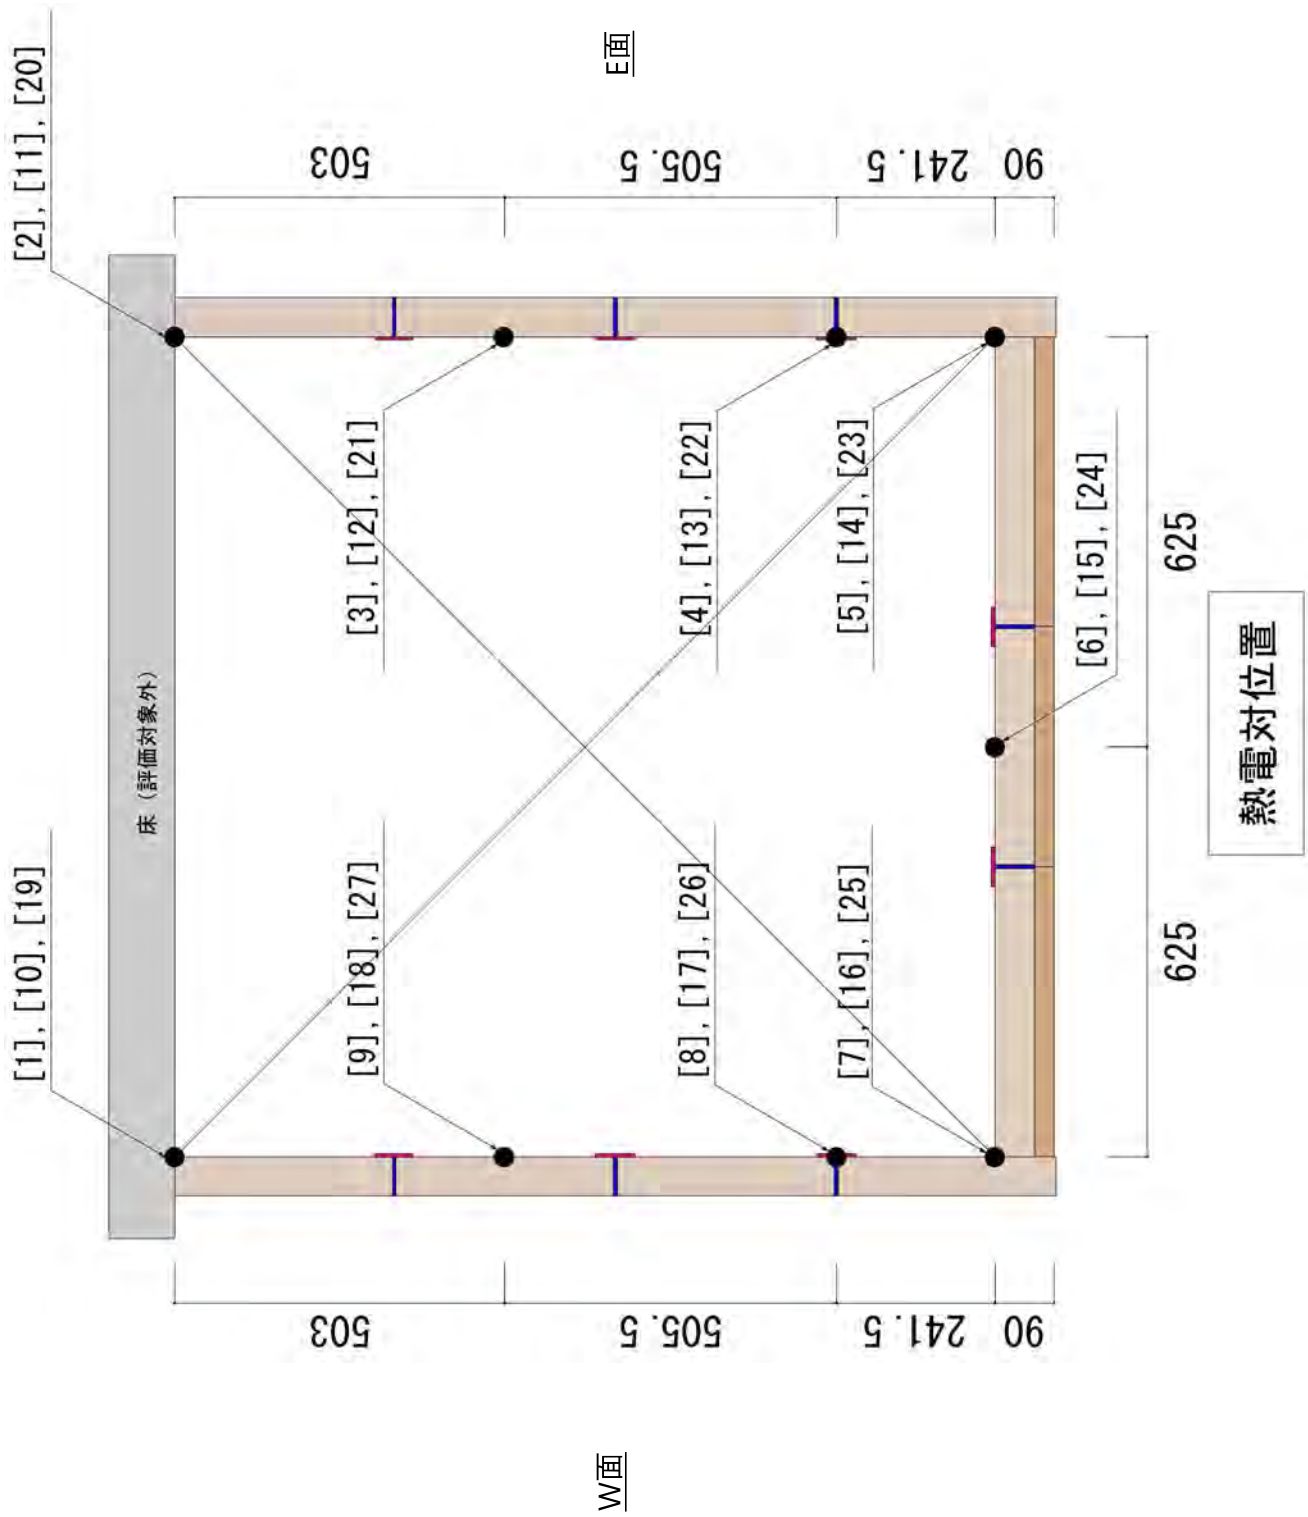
内部温度測定位置 (試験体B) (寸法単位: mm)
